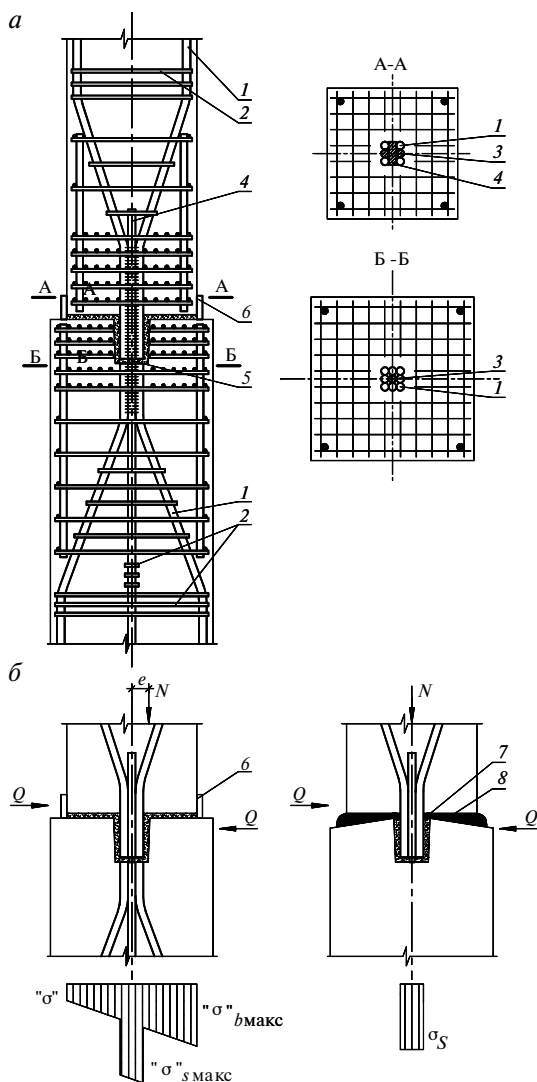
Стык сборных железобетонных колонн – а; расчетные схемы маломоментного – б и безмоментного (шарнирного) – в стыков:
